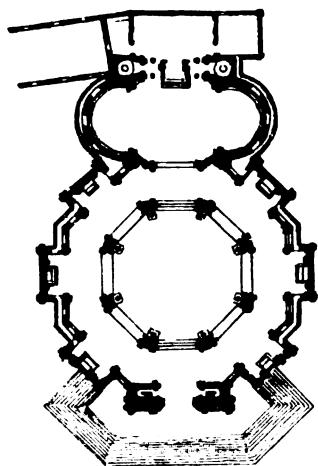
Grundriss der Kirche delle Salute in Venedig.
